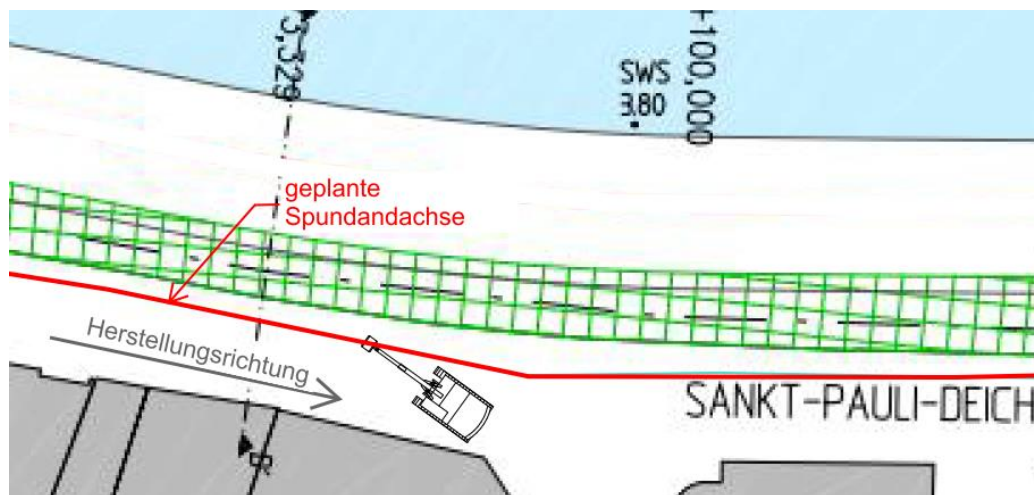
Spundwandeinbringung Bereich „Sankt-Pauli-Deich“, Grundriss
